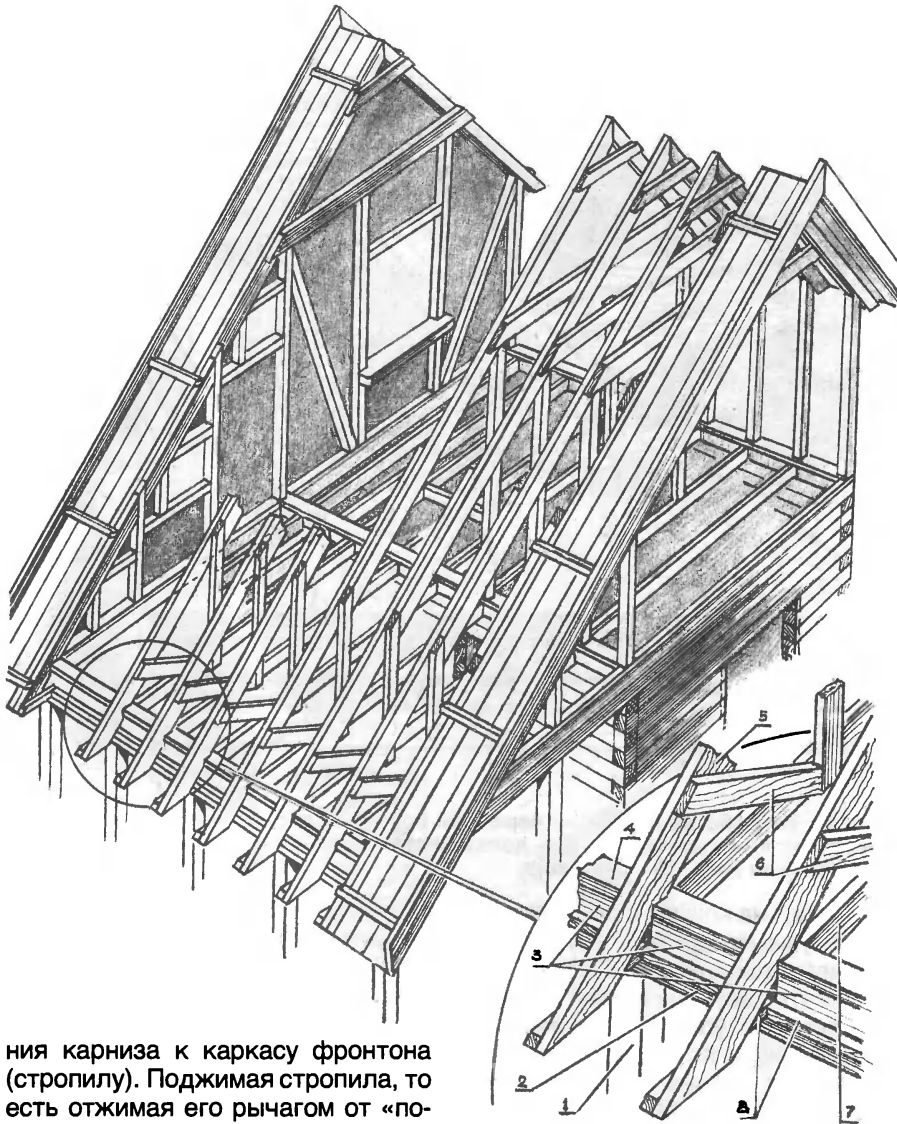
Изготовление фронтона: 1 — стропило, 2 — накладка, 3 — затяжка, 4 — прогоны, 5 — черепной брус, 6 — верхняя обвязка, 7 — балки перекрытия, 8 — временный настил для работы на перекрытии, 9 — упоры для изготовления стропильных ферм, 10 — раскосы, 11 — стойки мансарды.
